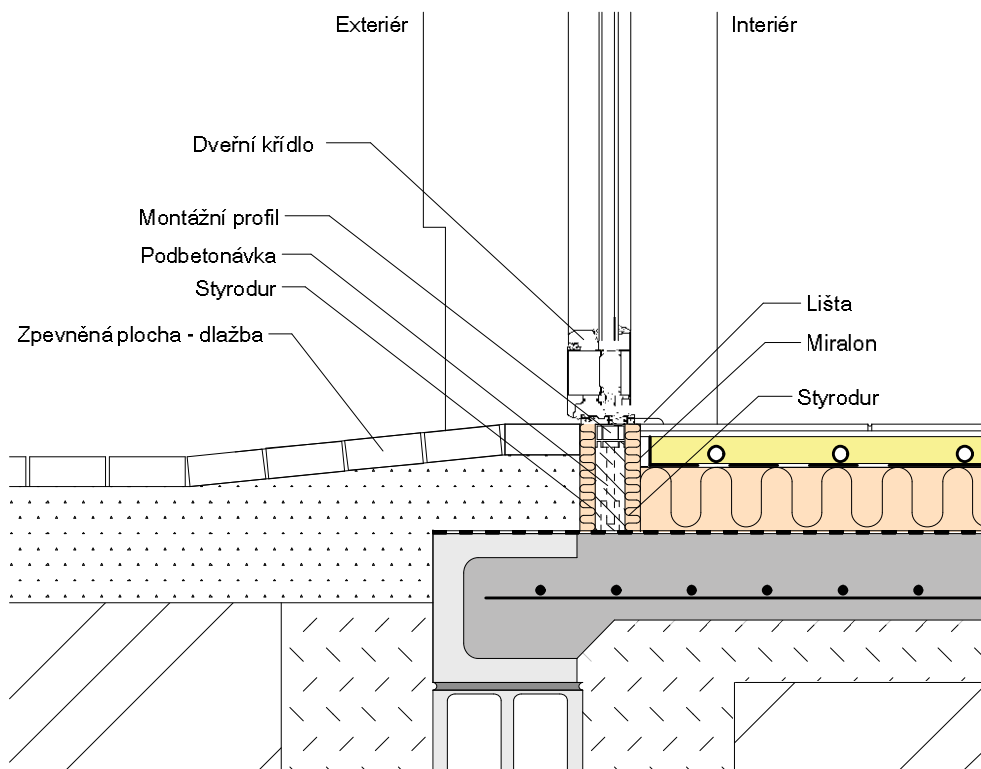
OBVODOVÁ STĚNA - DVEŘE PŮDORYSNÝ ŘEZ
